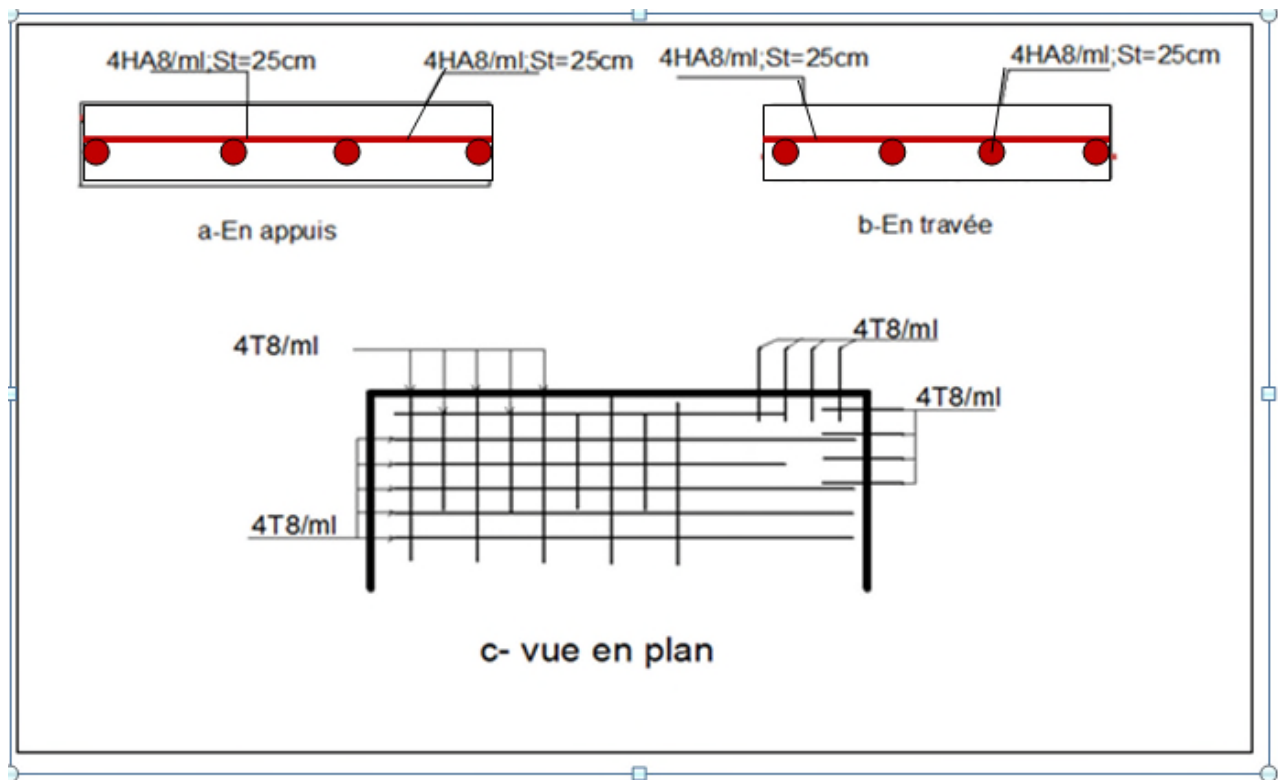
Schéma de ferrailage de la dalle sur deux appuis
